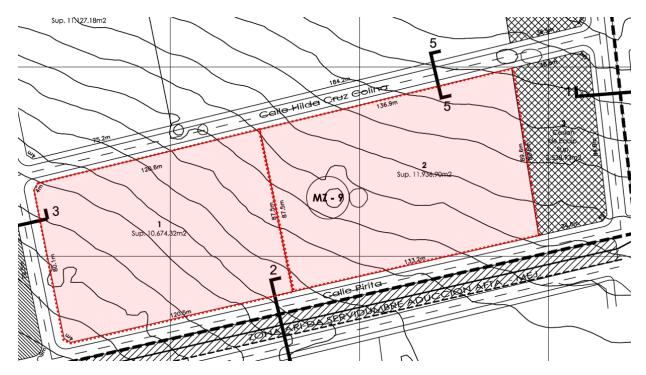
Ubicación Lotes 1 y 2 de la MZ-9. Fuente: Extracto Plano Anteproyecto de Loteo Etapa II, Seremi MINVU.
